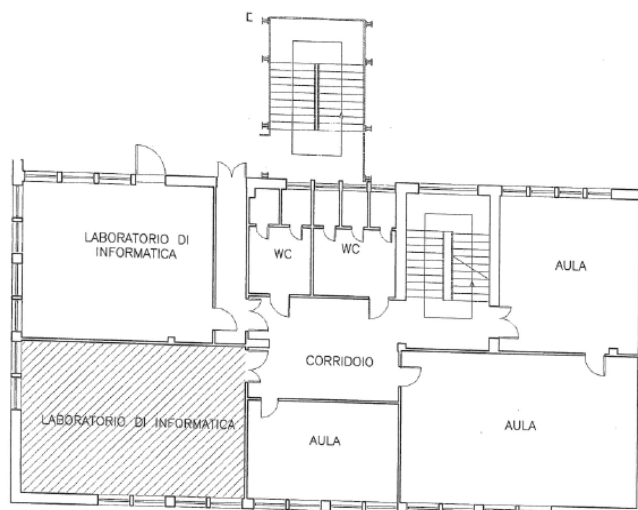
Zone d'intervento *SicurTECTO* – Piano Terra
